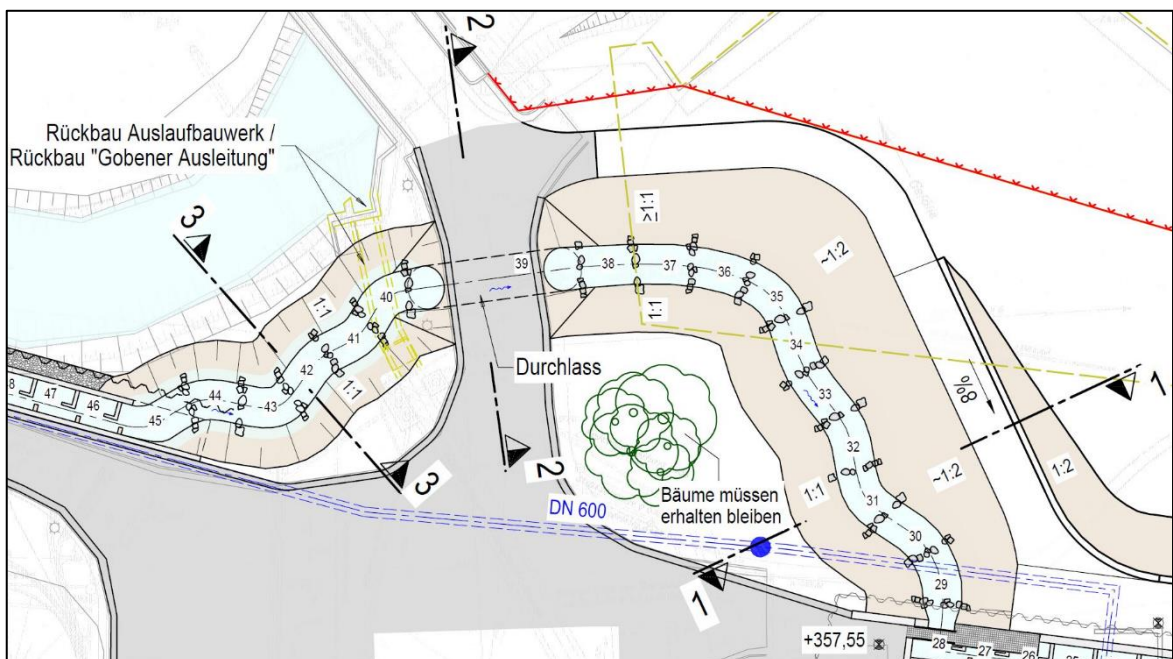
Draufsicht UW-Raugerinne-Beckenpass
